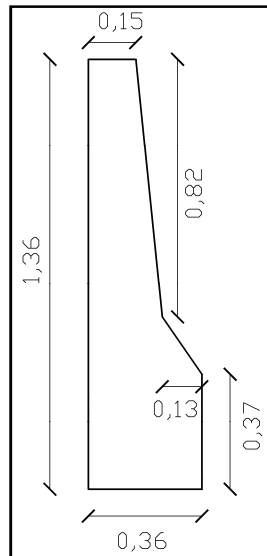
barrera F de hormigón sin pasamanos (dimensiones en m)
